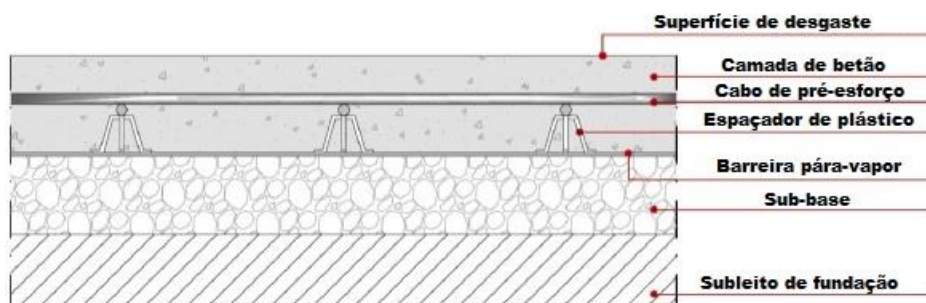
Pavimento de betão com armaduras de pré-esforço (Adaptado de [18]).
